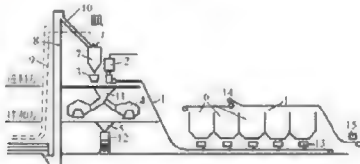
混凝土搅拌楼布置示意图（双阶式）
